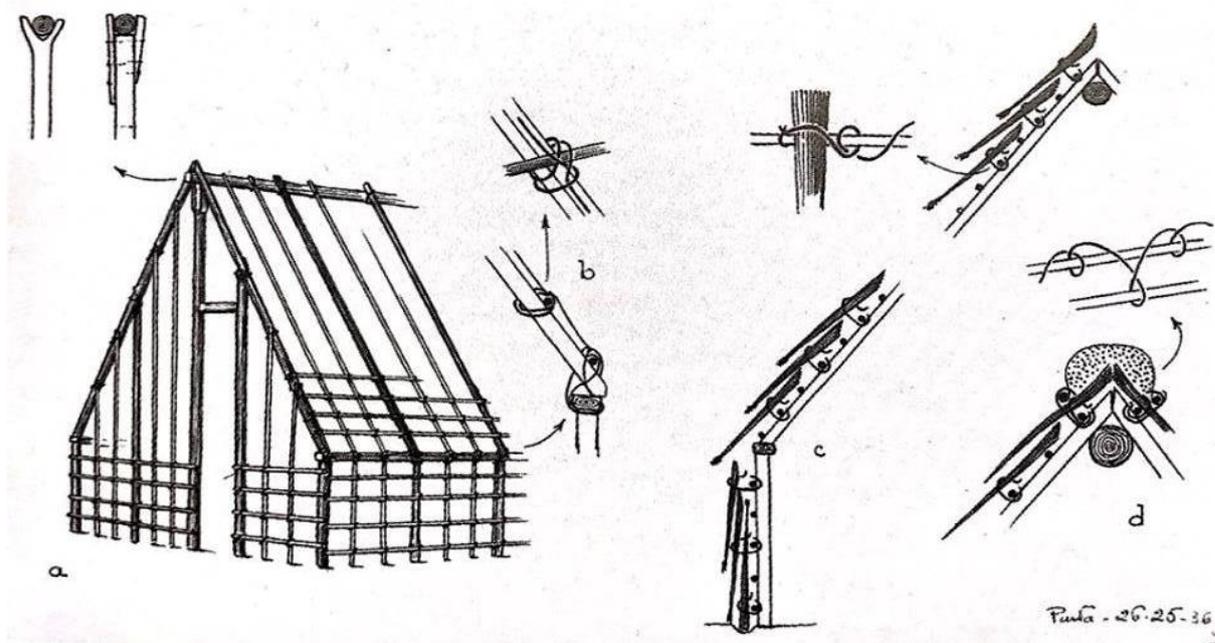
Ilustração técnica da aplicação de teto de palha. Fonte:(Prista, 2014:81).
